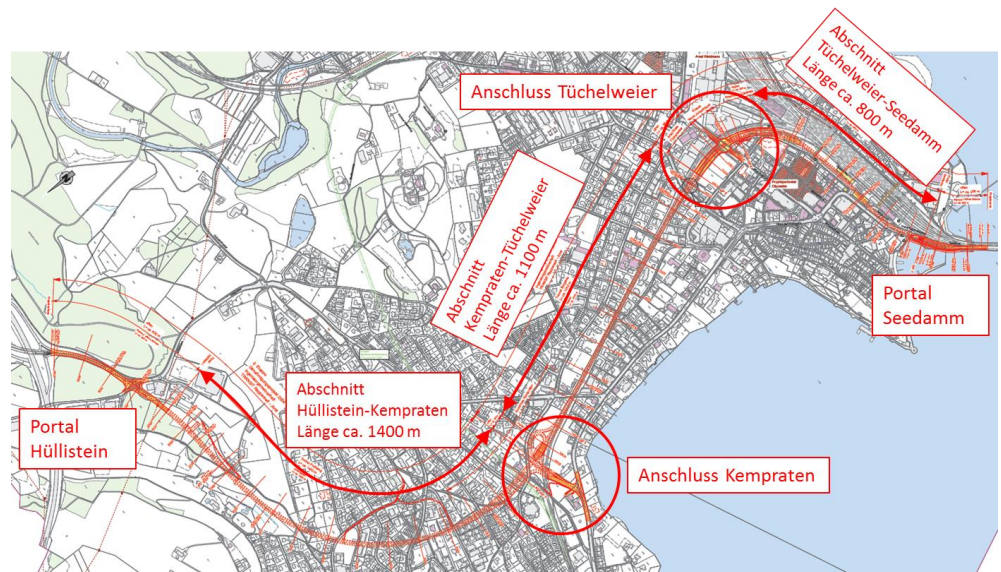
Situation Variante Mitte (aus Planbeilage 04-21)
